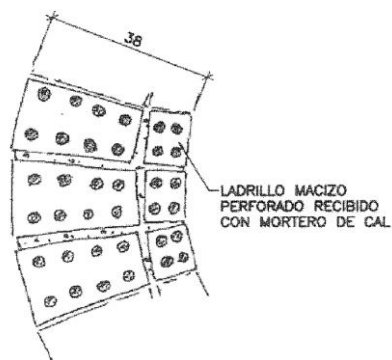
c.. Detalle del muro de la chimenea de ladrillo
